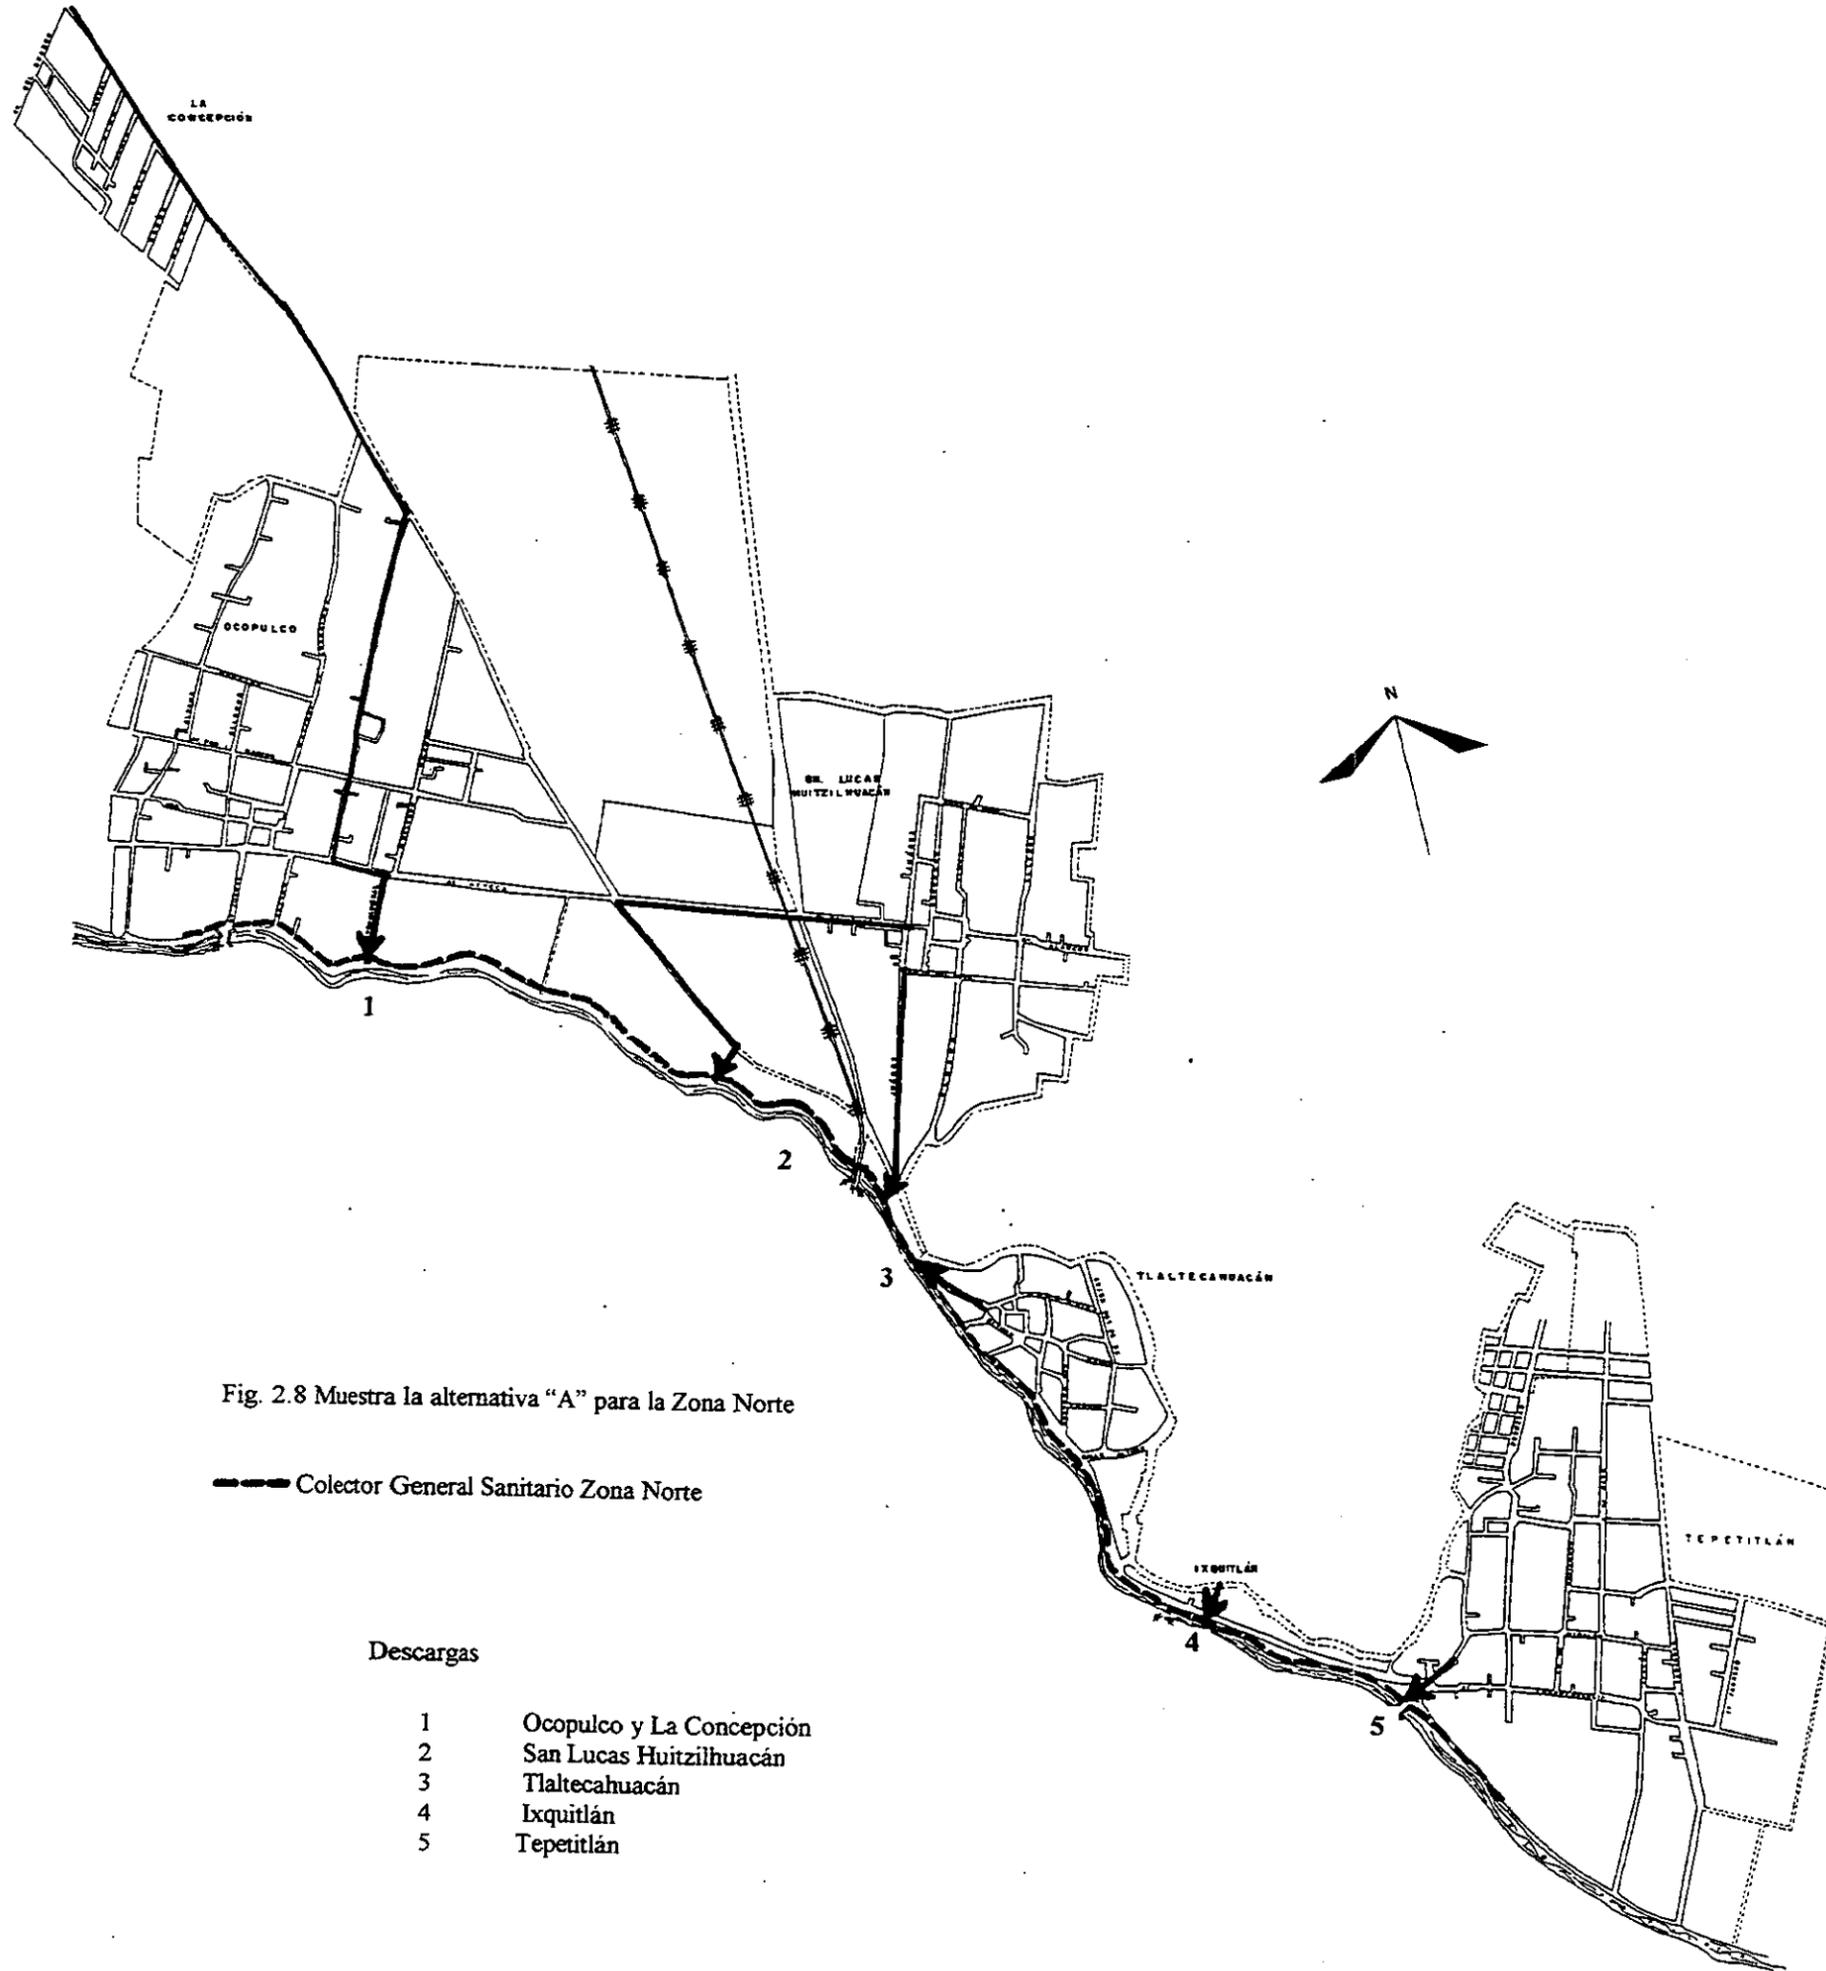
Muestra la alternativa "A" para la Zona Norte
